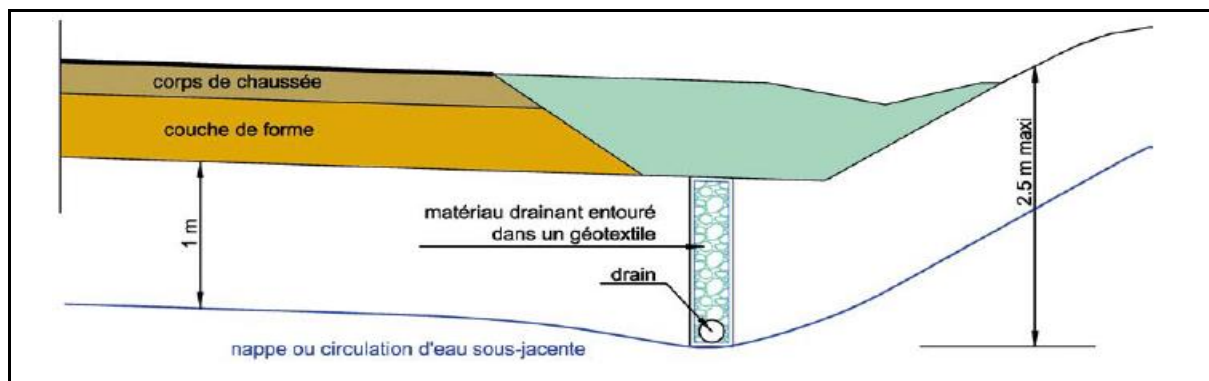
Schéma de positionnement d'une tranchée drainante [2].
